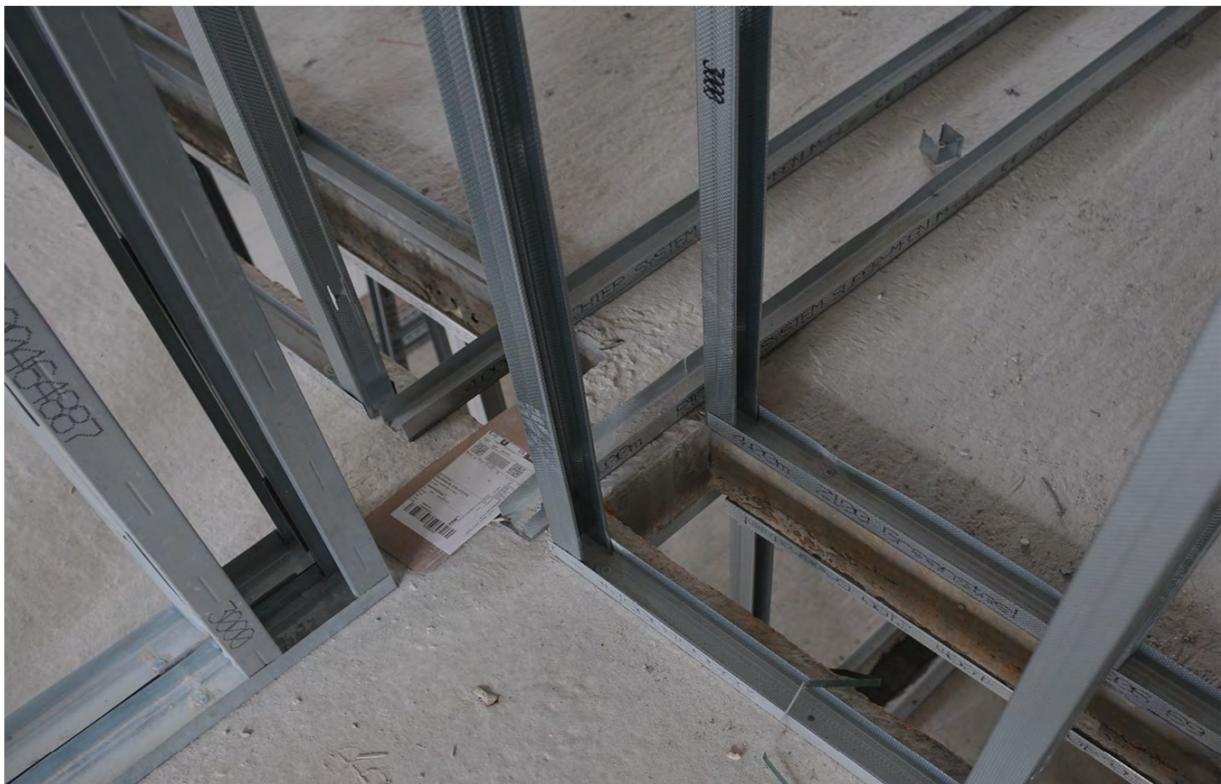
Installationsschächte im Bereich der Apartment-Bäder, 30.08.2018
